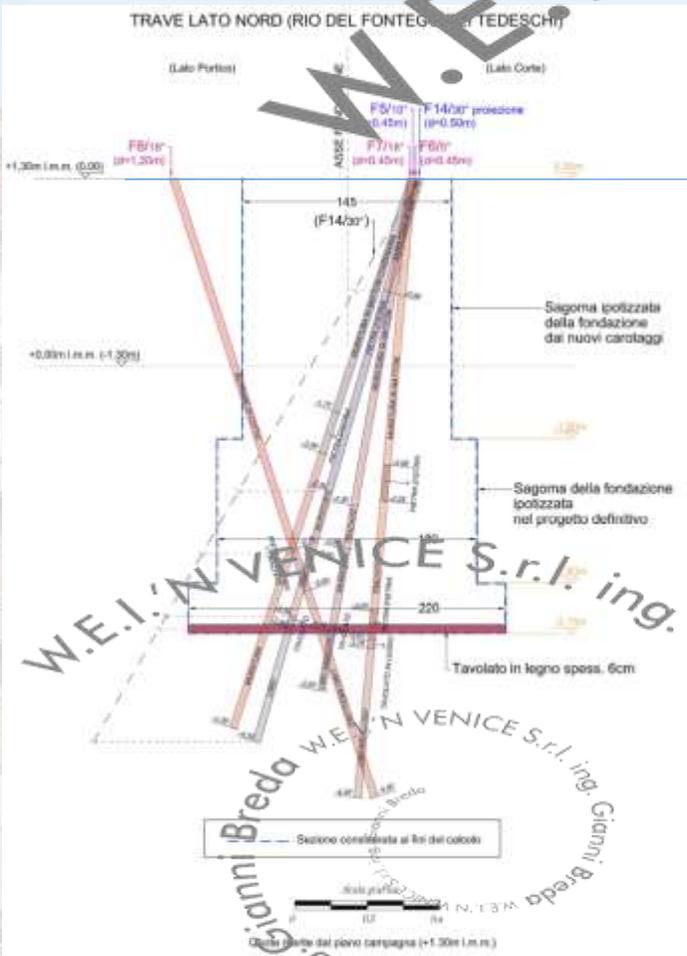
sezione tipo e carotaggi fondazione muro lato Nord
